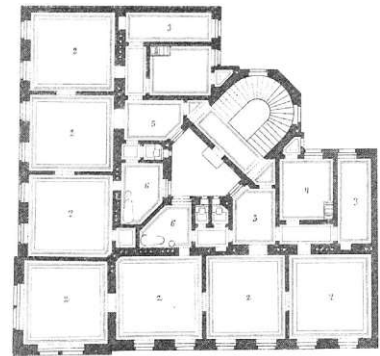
Grundriss 1. Obergeschoss, Kolschitzkygasse 5 - Heinrich Adam, 1887
